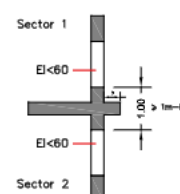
ENCUENTRO FORJADO-FACHADA CON SALIENTE
